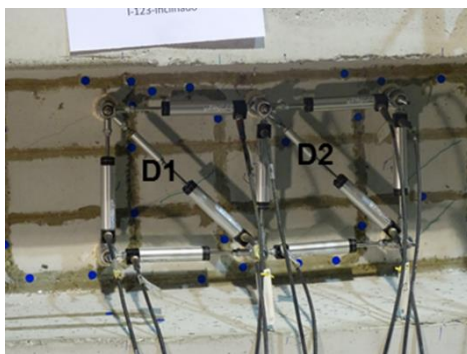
Potenciómetros diagonales de la viga I-2
